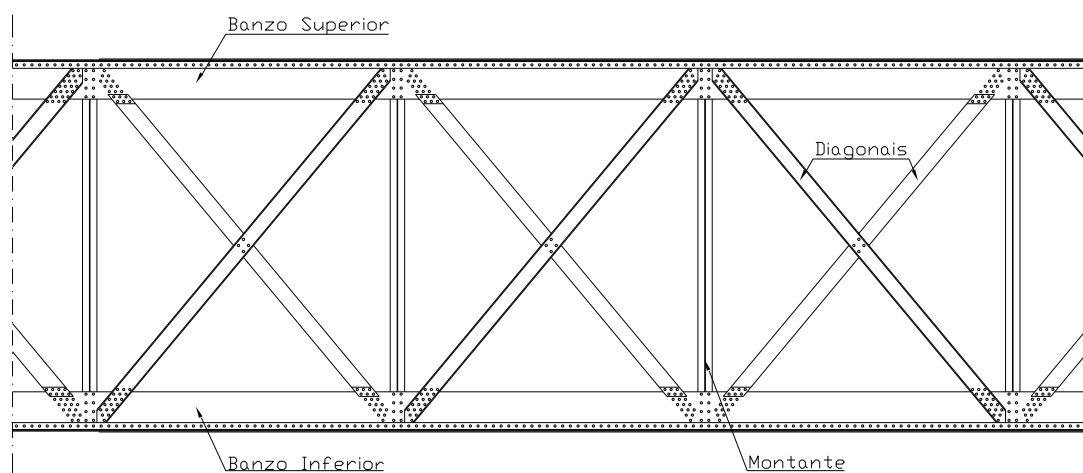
Pormenor de um alçado - Viga treliçada constituída por banzos, diagonais e montantes
